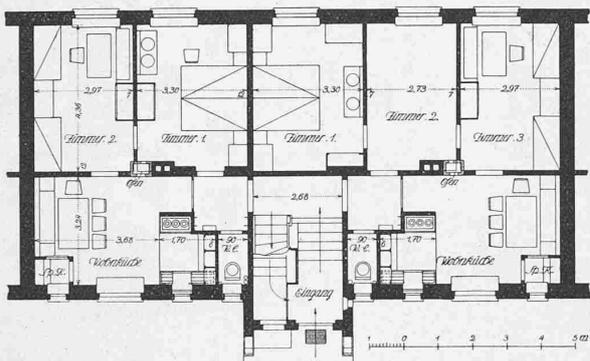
und 9. Grundriss und Schnitt der Kleinwohnungshäuser an der Bertastrasse in Zürich. — 1 : 200.
